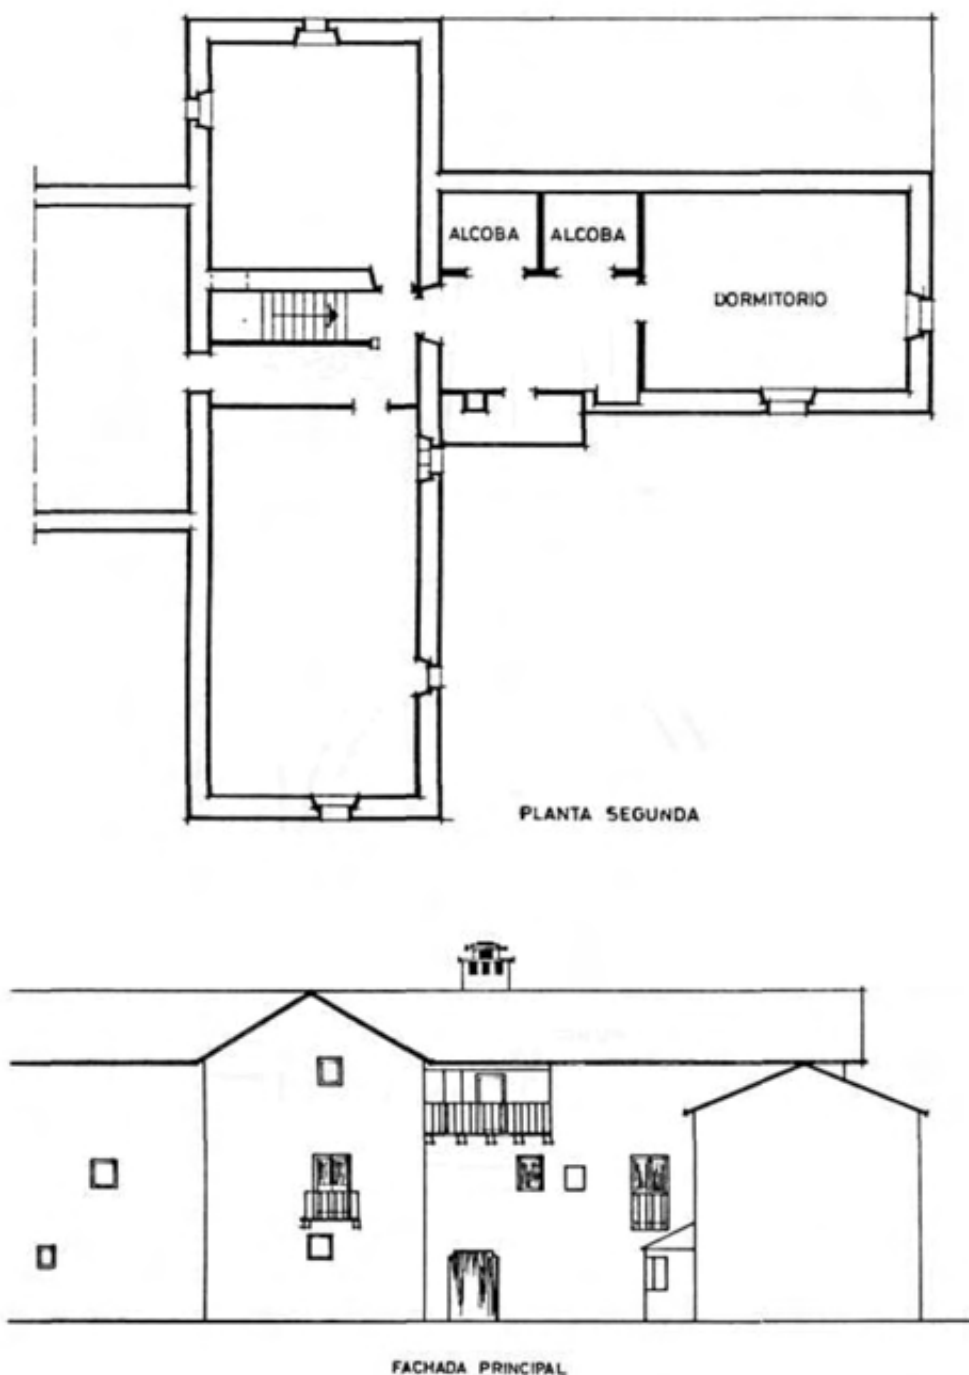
Casa López, en Sabiñánigo (planta segunda y fachada principal).
